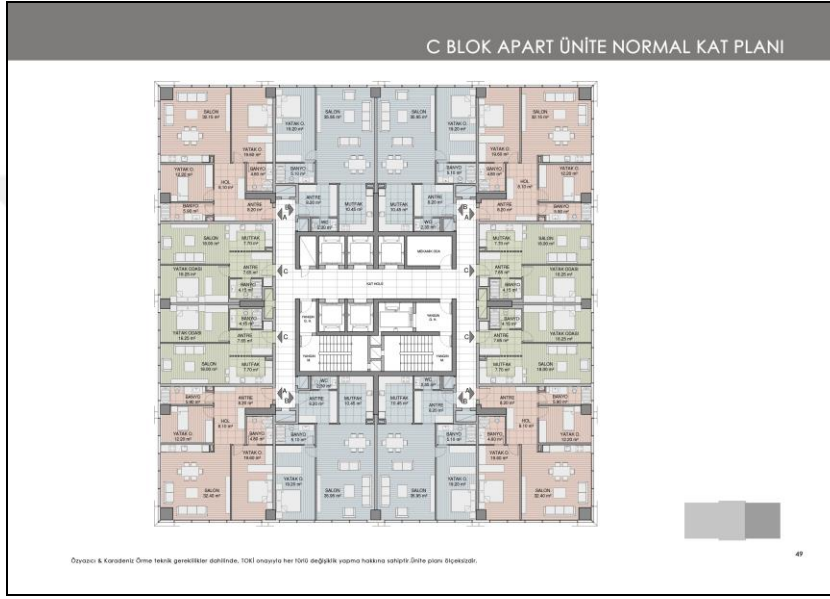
Yalı Ataköy 5. kat planı (Katalog)
